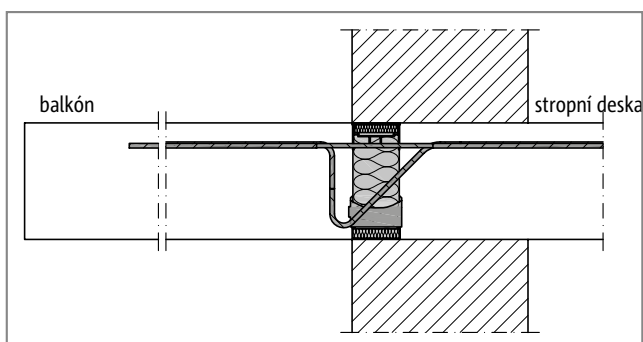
Schöck Isokorb® typ K: Balkón na vnějším rohu
